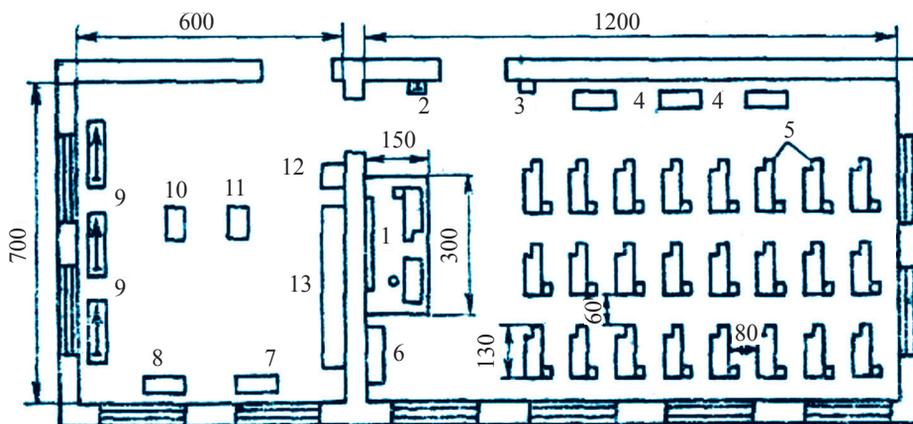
Примерный план расположения рабочих мест в столярных учебных мастерских: 1 – рабочее место учителя; 2 – умывальник; 3 – аптечка; 4 – шкаф для принадлежностей и материалов; 5 – станки; 6 – шкаф для учебно-наглядных пособий; 7, 8, 9, 10, 11 – фрезерные, сверлильные, токарные станки для обработки дерева, строгальные, распиловочные станки; 12 – точильный станок; 13 – полка для материалов.
